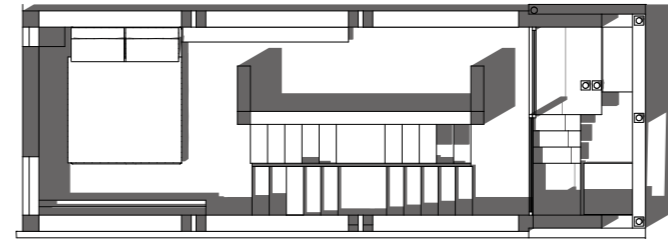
Diagrama de piezas de hormigón de Kobe Layer House
